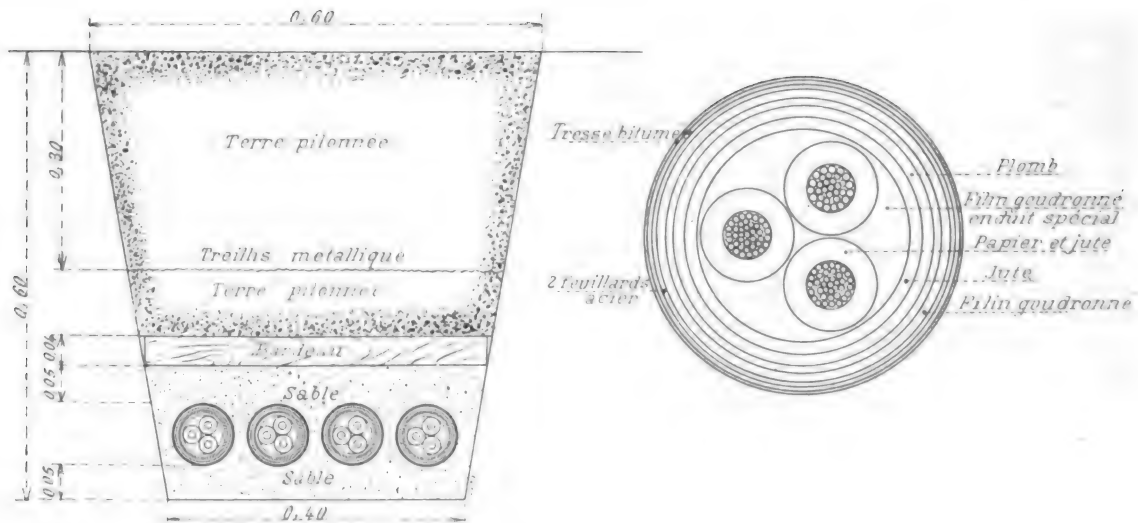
Coupe d'une tranchée montrant la pose des câbles et coupe type d'un câble triphasé.
